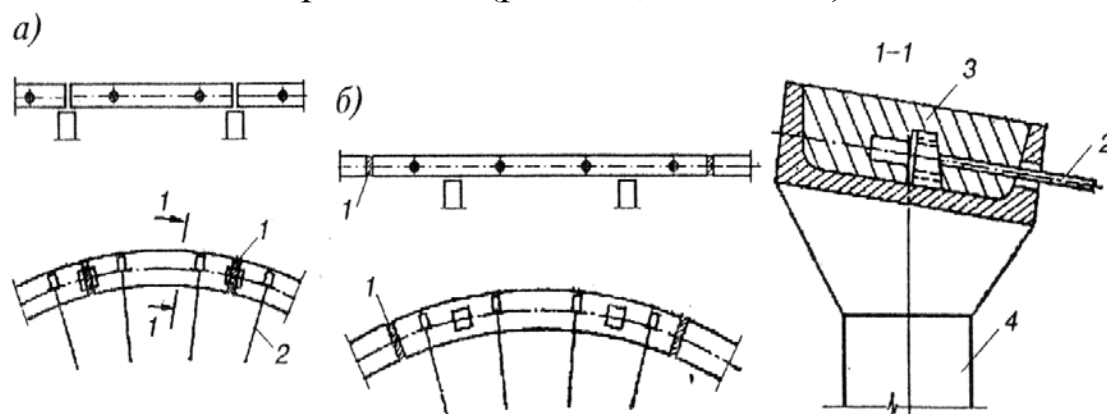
Наружные железобетонные кольца: а – стыки колец на колоннах; б – то же, в пролёте; 1 – стыки; 2 – канаты; 3 – бетон замоноличивания; 4 – колонна
